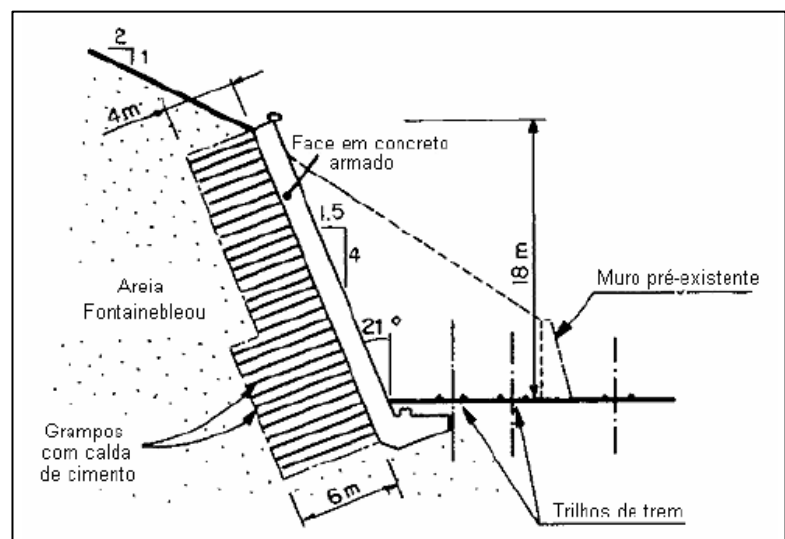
Primeira estrutura em solo grampeado documentado, em Versailles - França
